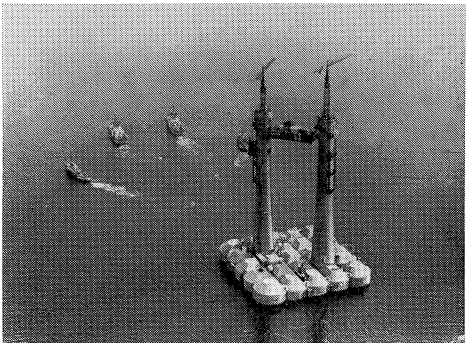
Die Betonkonstruktion ist vollendet und wird nach Loch Fyne verschleppt um die Stahlkonstruktion auf den Türmen zu montieren.
